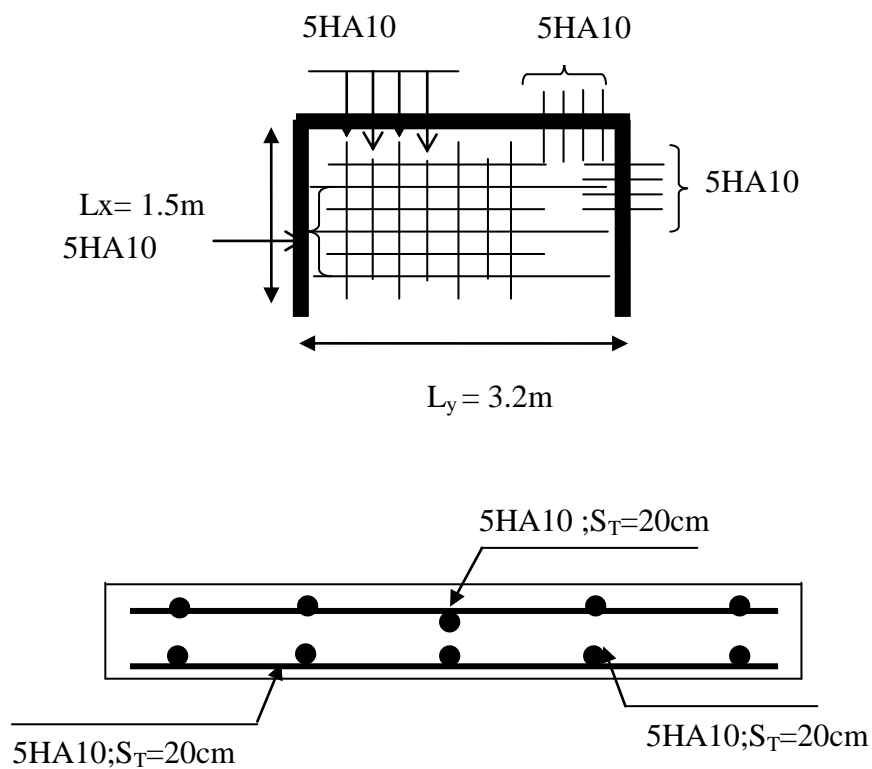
Schéma de ferrailage de la dalle sur 3 appuis
